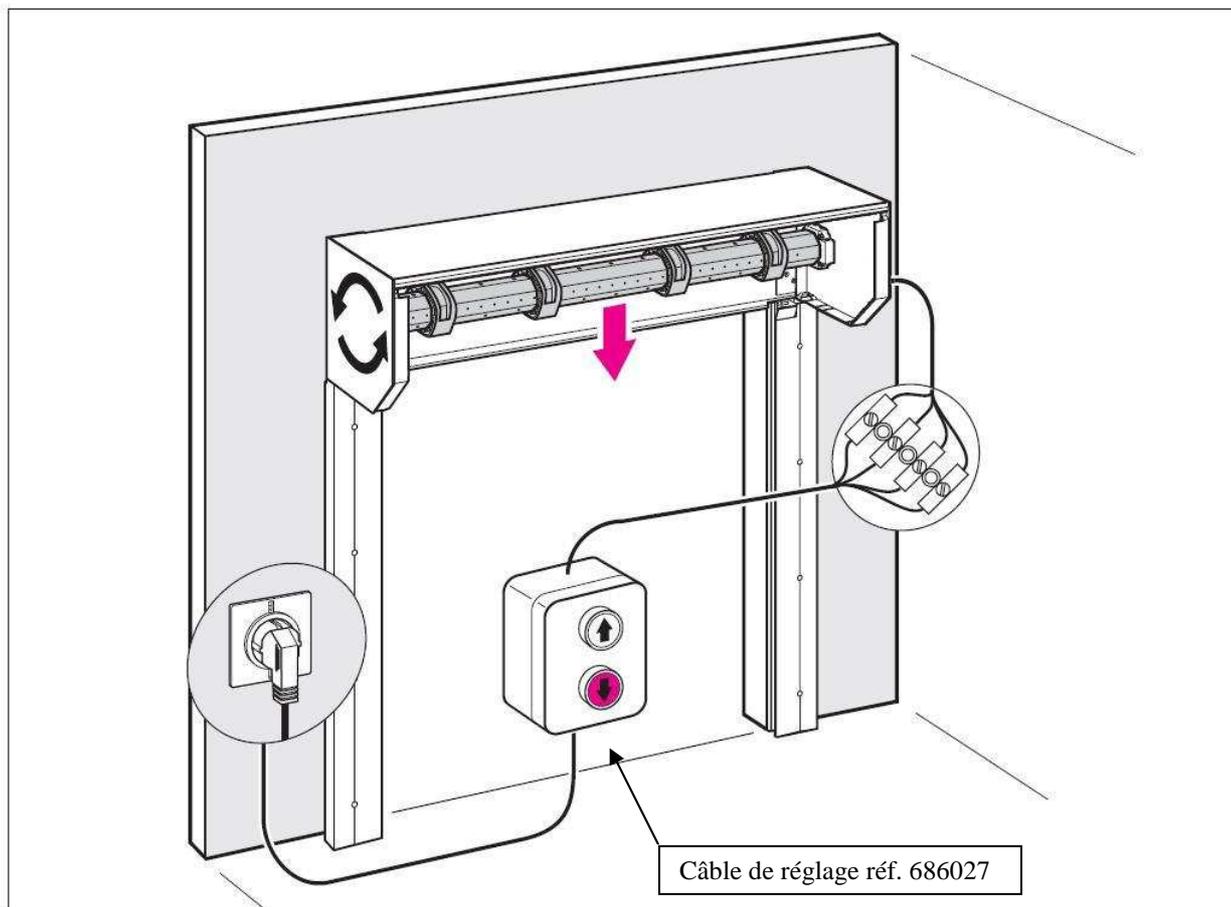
Vue d'ensemble branchement du câble de montage
